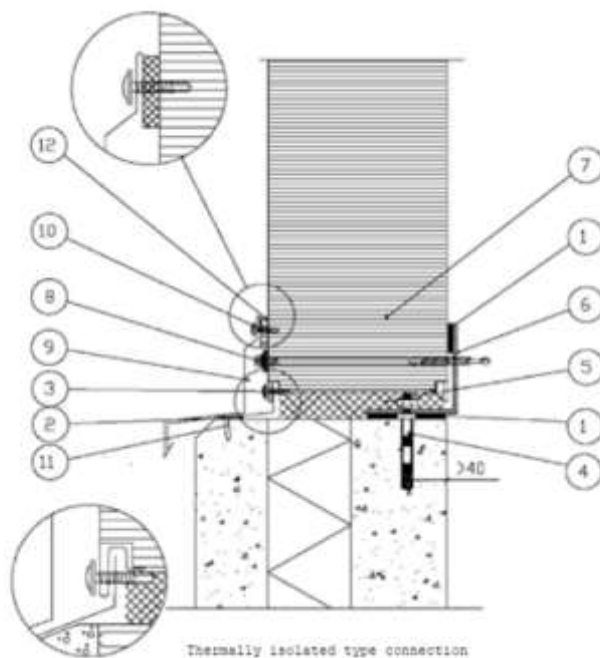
Startprofiel loopt door en betonblad is dikker dan staal sandwichpaneel.
